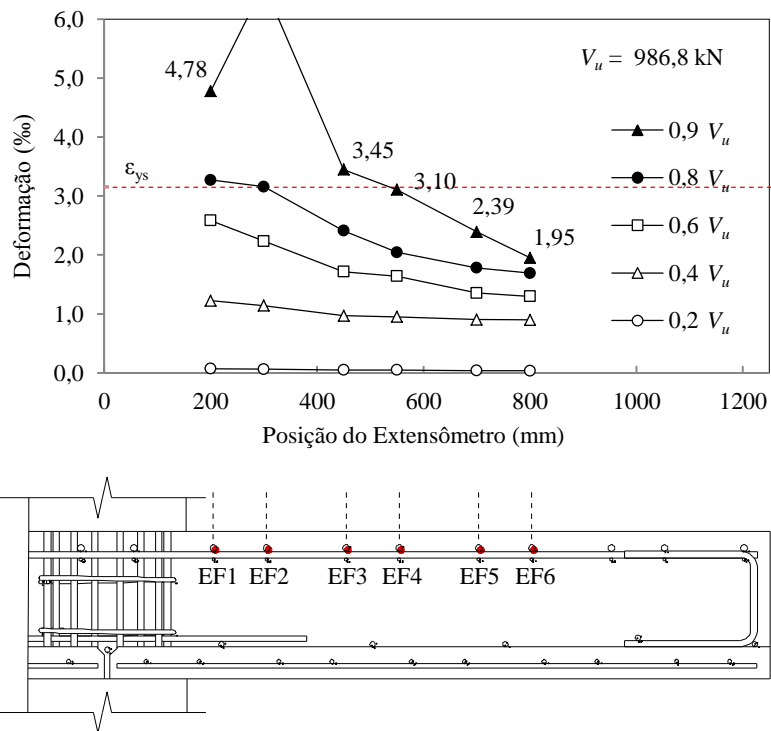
Deformações nas armaduras de flexão da laje SS2
